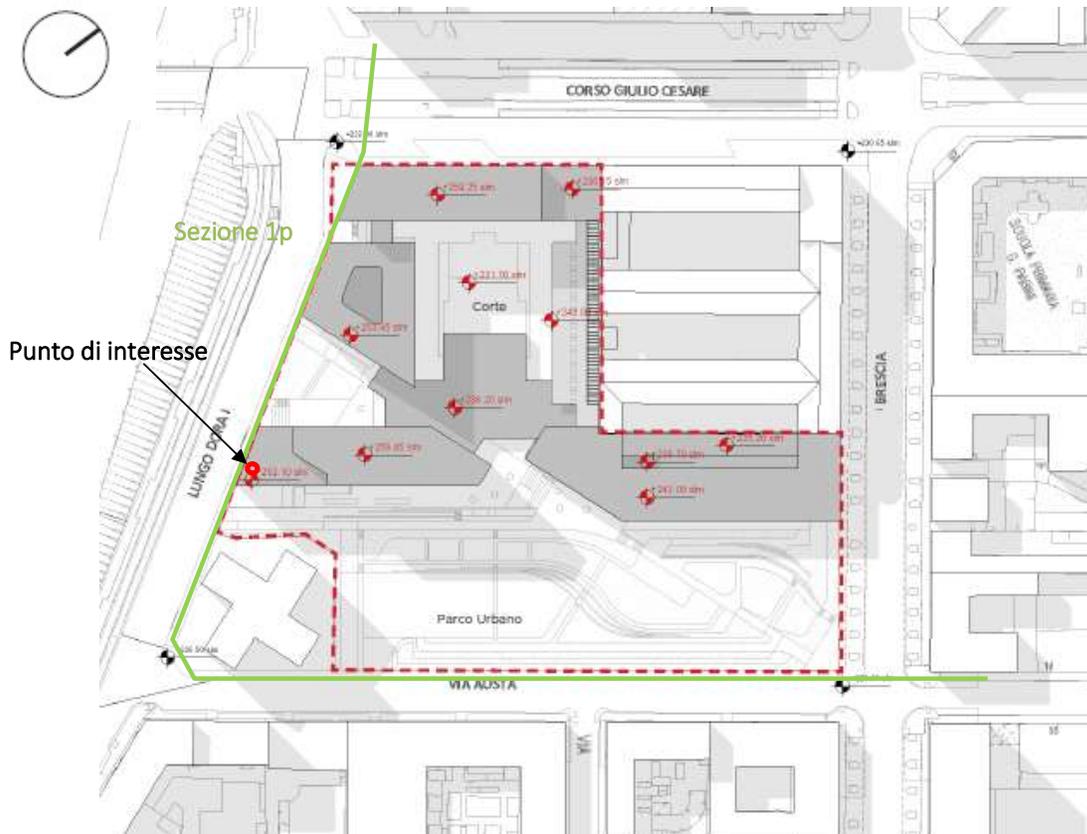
Planimetria Rilievo area di intervento Stato di Fatto e ubicazione Sezione 1
